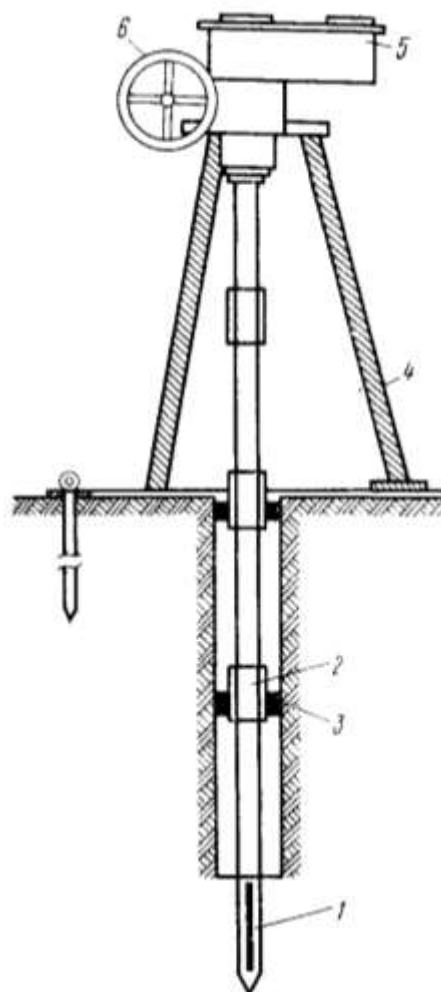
Схема установки вращательного среза СП-52. 1 — крыльчатка; 2 — штанга с муфтами; 3 — центрирующее устройство; 4 — станина; 5 — измерительное устройство; 6 — штурвал
